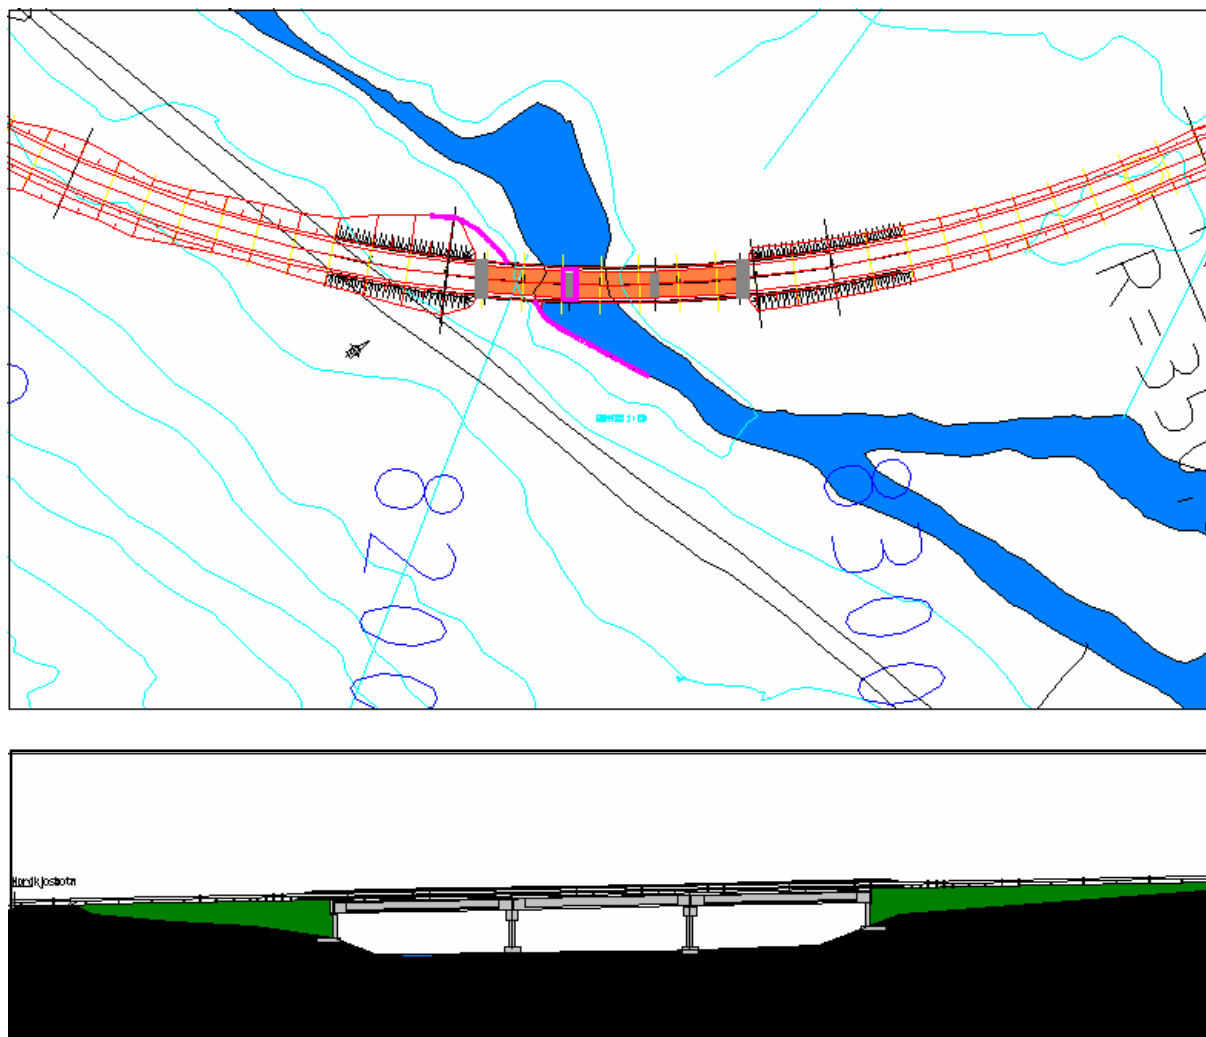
Brukryssing alt. 5 og 7 ved Smørpundfossen - bruplassering og utforming i plan og profil samt nødvendig erosjonssikring vist med lilla strek i plan
